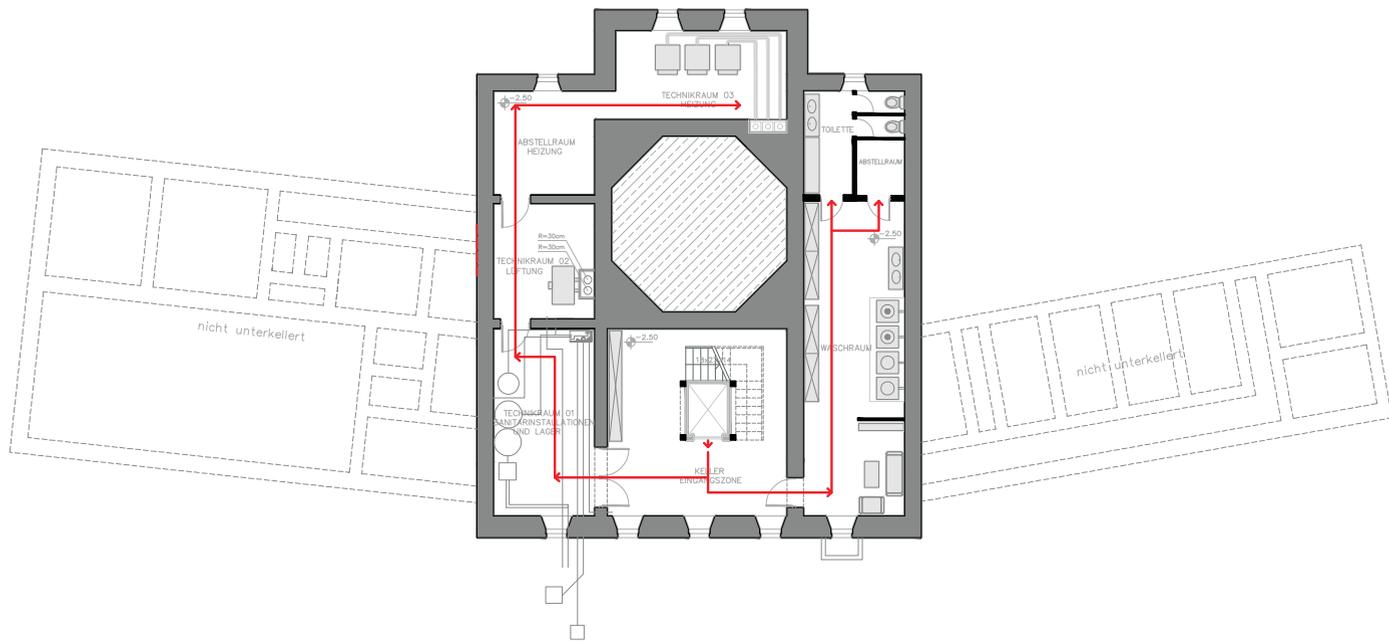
Grundriss Keller (Gehlinie)
